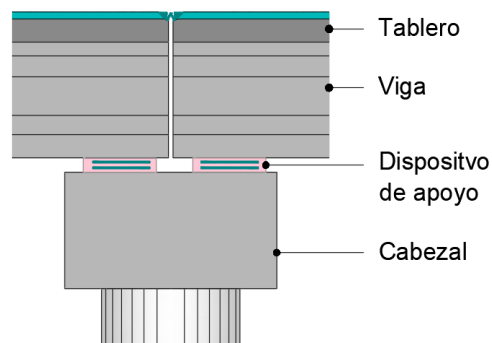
Esquema de los dispositivos de apoyo en puentes
